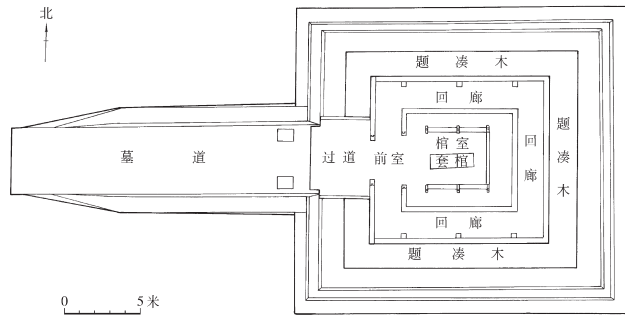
湖南省长沙市象鼻嘴 1 号墓平面图 (1/500)
